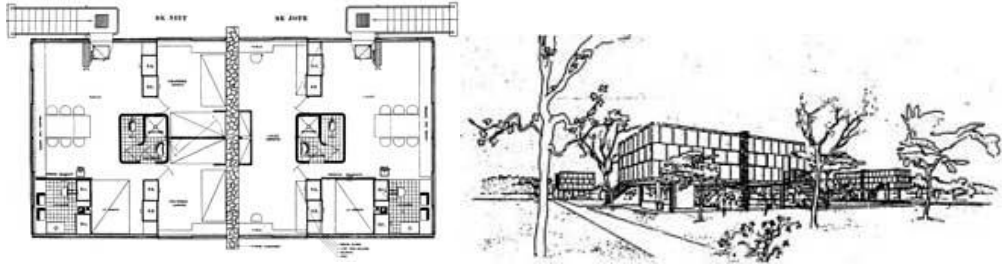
Hufeisensiedlung konut bloğu plan ve dış cephe görünüşü (Schneider & Till, 2007, p. 58).
